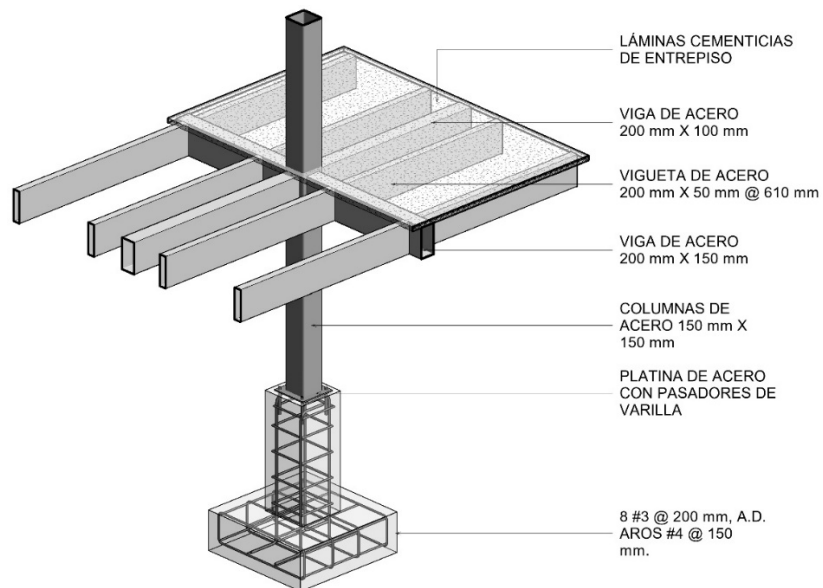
Detalle de cimentaciones y componentes estructurales del anteproyecto en estructura de acero.
